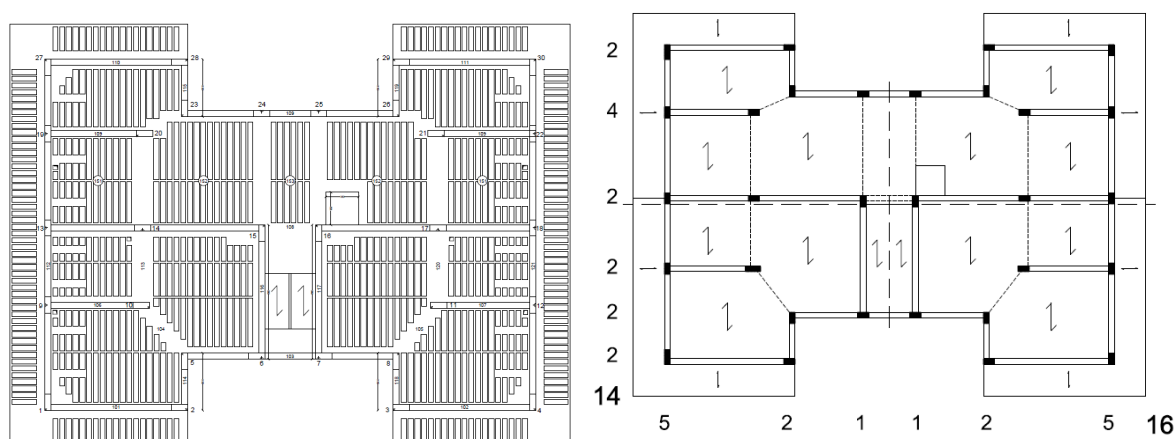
Distribuzione dei pilastri nella carpenteria tipo
